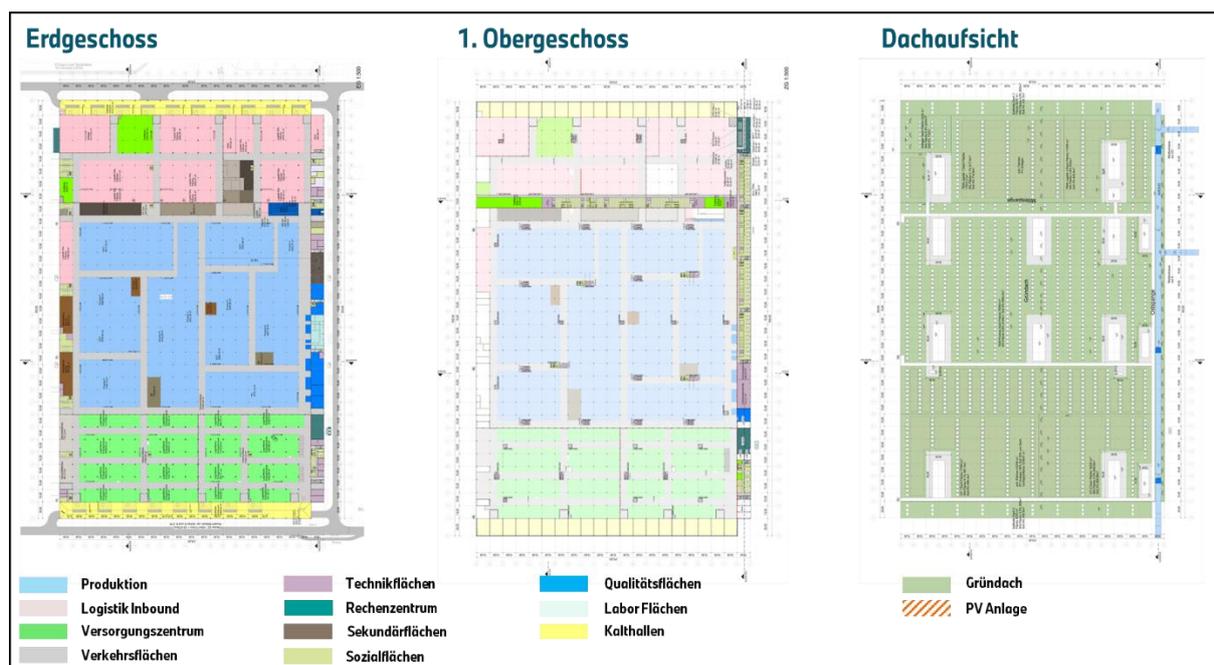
TEM/ VZ Grundriss EG, 1.OG, Dachaufsicht.
